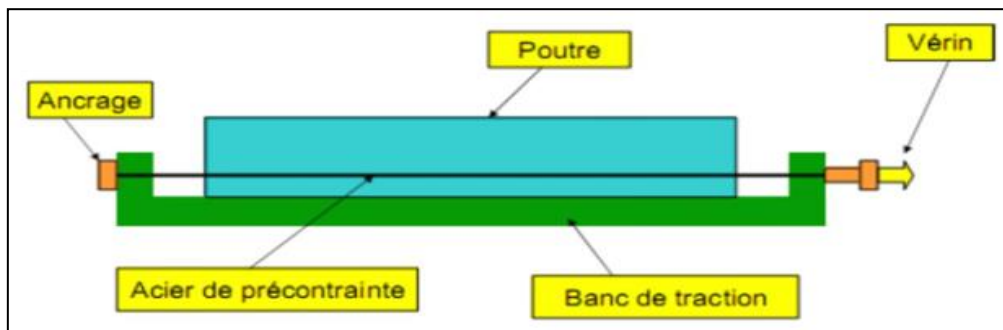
Coupe longitudinale d'une poutre en béton précontraint par pré-tension.
